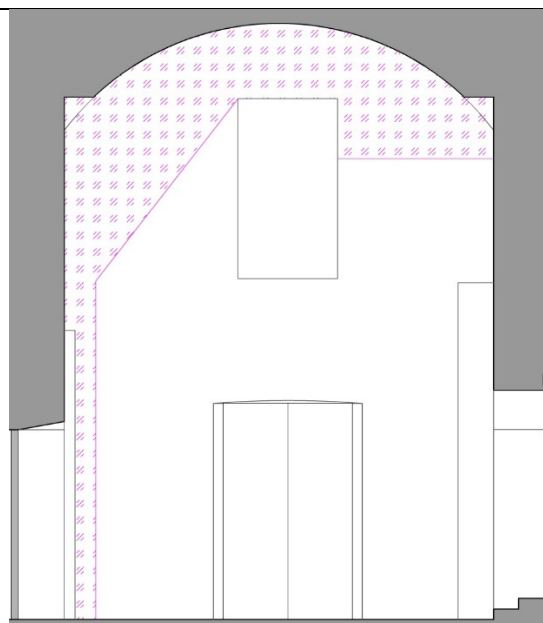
Lesión Q4- Alzado-sección Biblioteca
